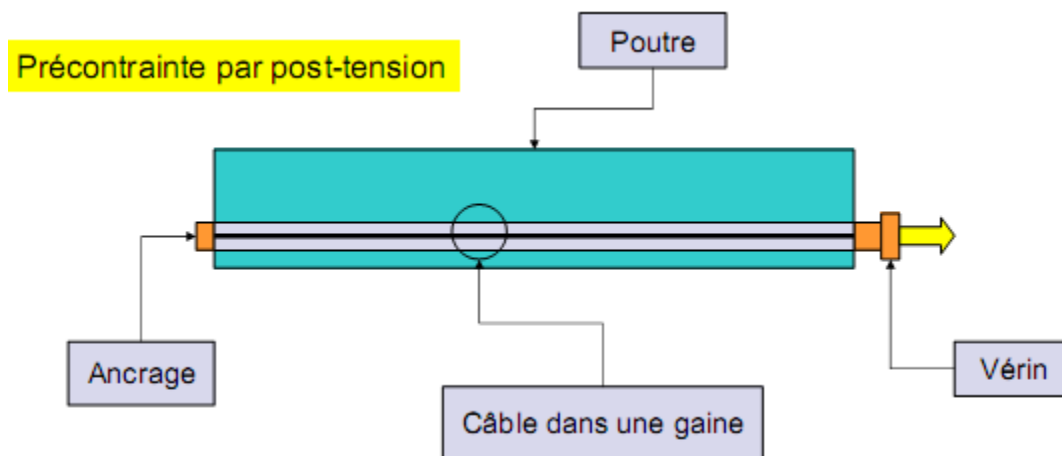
Coupe longitudinale d'une poutre en béton précontraint par post tension
